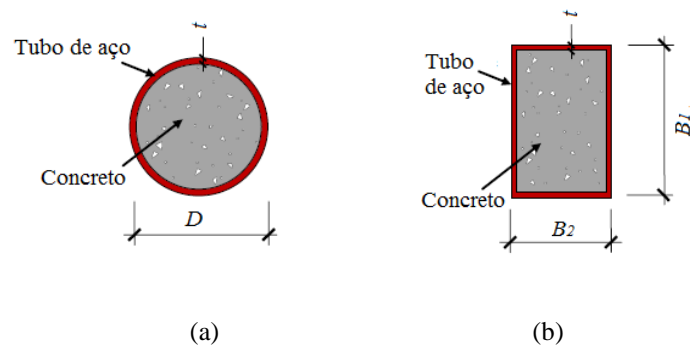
Seção transversal de pilares mistos preenchidos com concreto: (a) PMPC constituído por uma seção circular; (b) PMPC constituído por uma seção retangular. (Han *et al.*, 2014)
